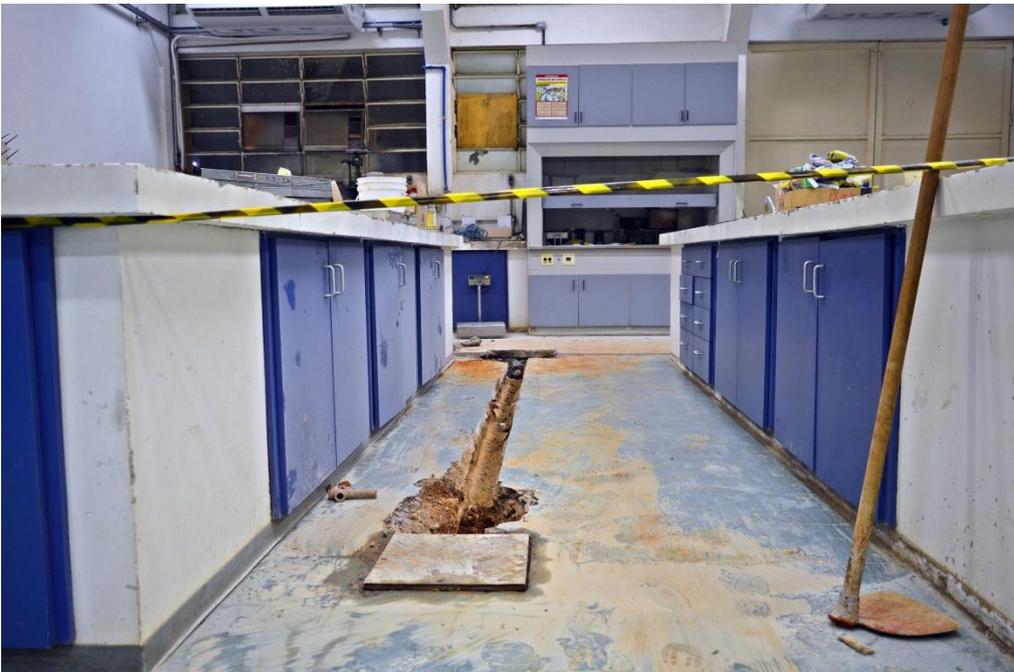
Laboratório de Materiais de Construção - Adequações das instalações hidráulicas
